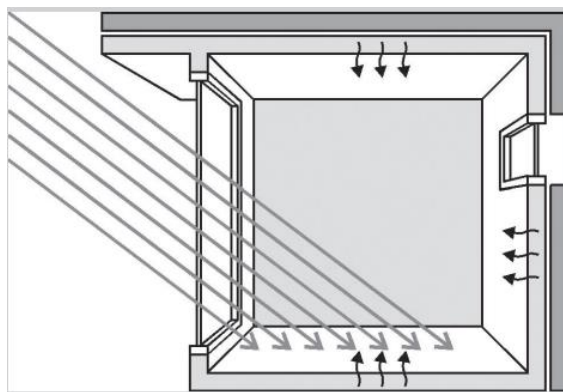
Sistema de aquecimento passivo de ganho direto [56]
